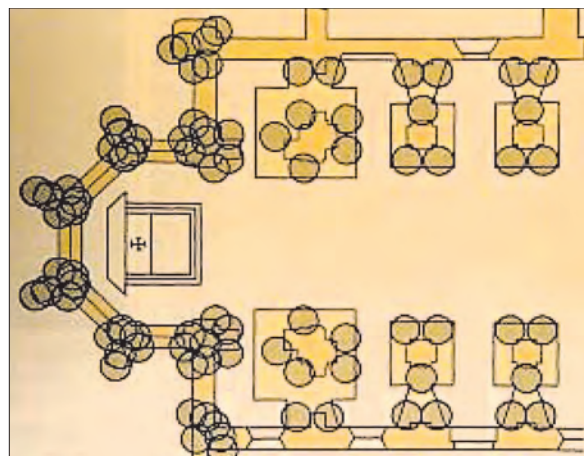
RECALCE BAJO ZAPATAS CON COLUMNAS DE JET.
